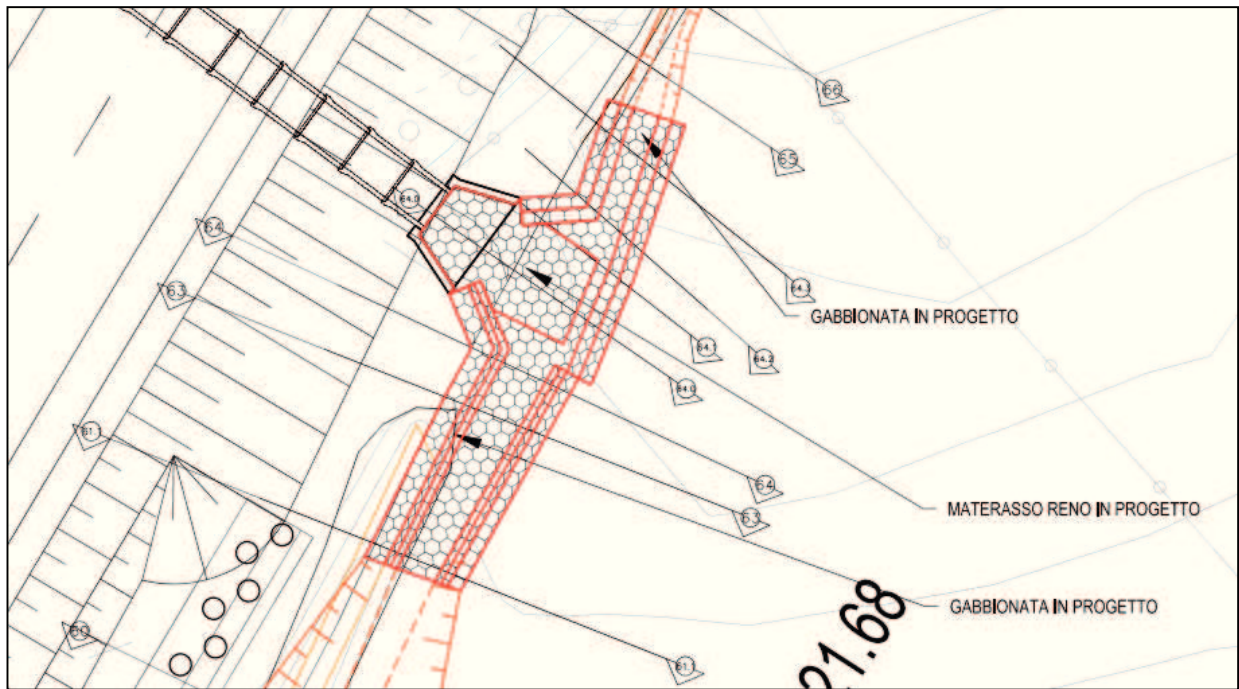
Stralcio planimetria interventi in progetto fosso 2.
